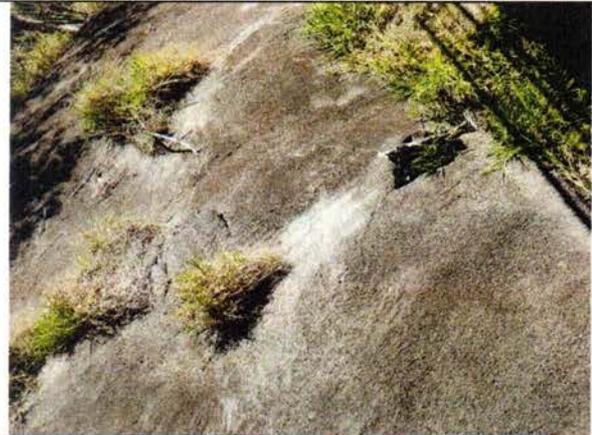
Outras fissuras e rachaduras, observadas no revestimento de concreto, condenando todo o processo de contenção do solo;
